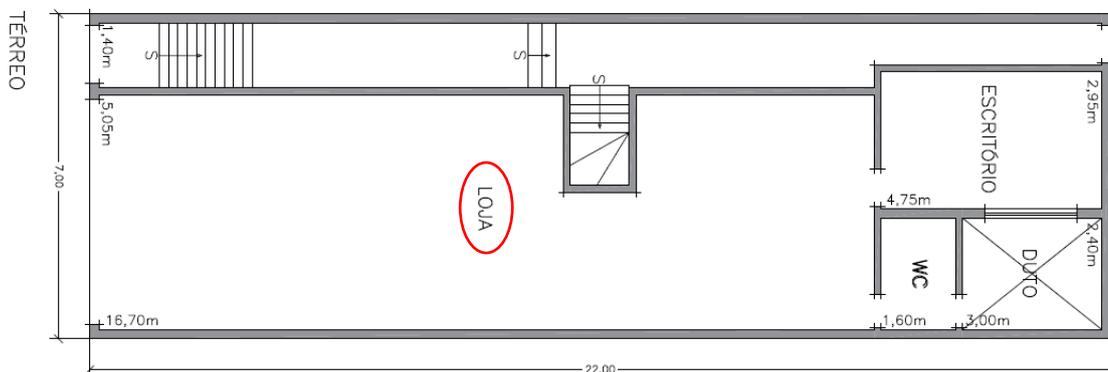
Planta baixa do pavimento térreo da edificação avaliada. Destaque para a loja e para o corredor lateral e escada que dão acesso aos apartamentos dos pavimentos superiores.
